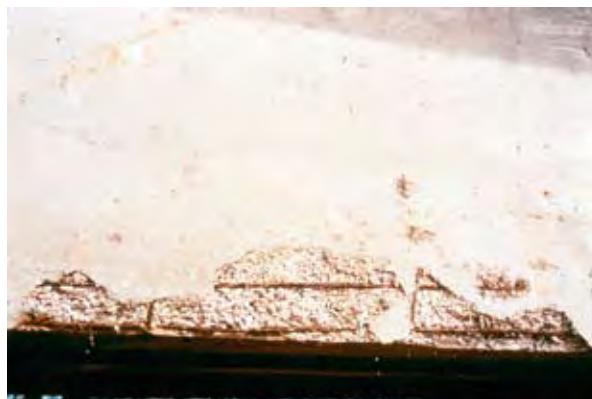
éclatement de béton et armatures corrodées sur le talon d'une poutre de VIPP, par défaut de positionnement du coffrage et donc d'enrobage des aciers – Source : RST
